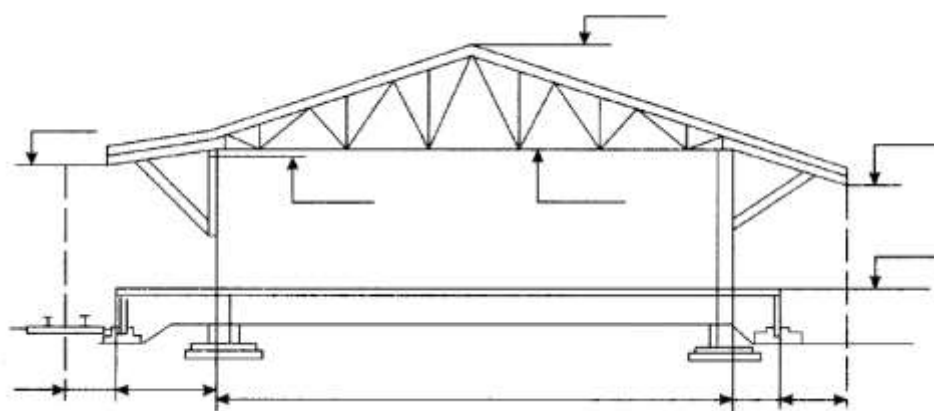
Крытый прирельсовый склад для переработки тарно-упаковочных грузов.
